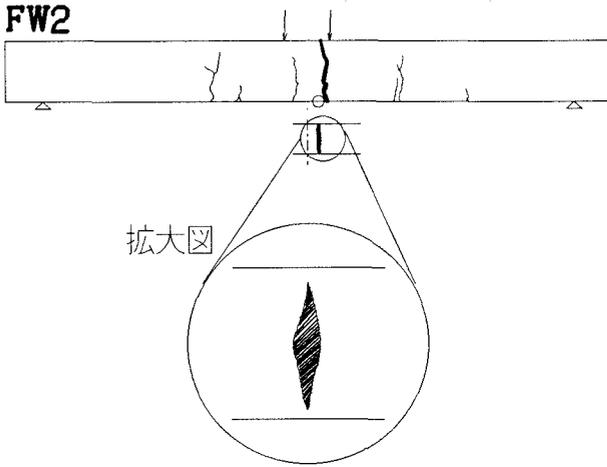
コンクリートのひび割れ及び鋼板の亀裂の性状
